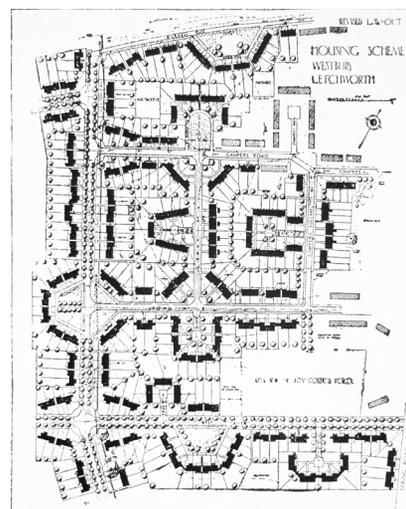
Letchworth, Detailplan für ein Kleinwohnungsgebiet
